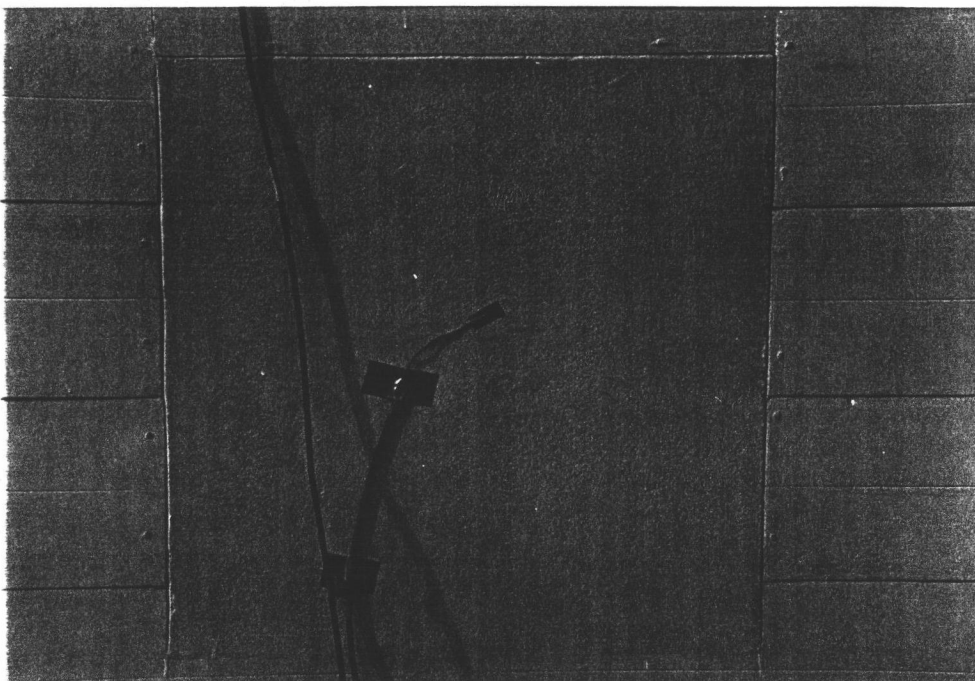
4. ผนังก่ออิฐฉาบปูนฉาบฉนวน ICC. (4" Masonry Wall with ICC. Insulation)
